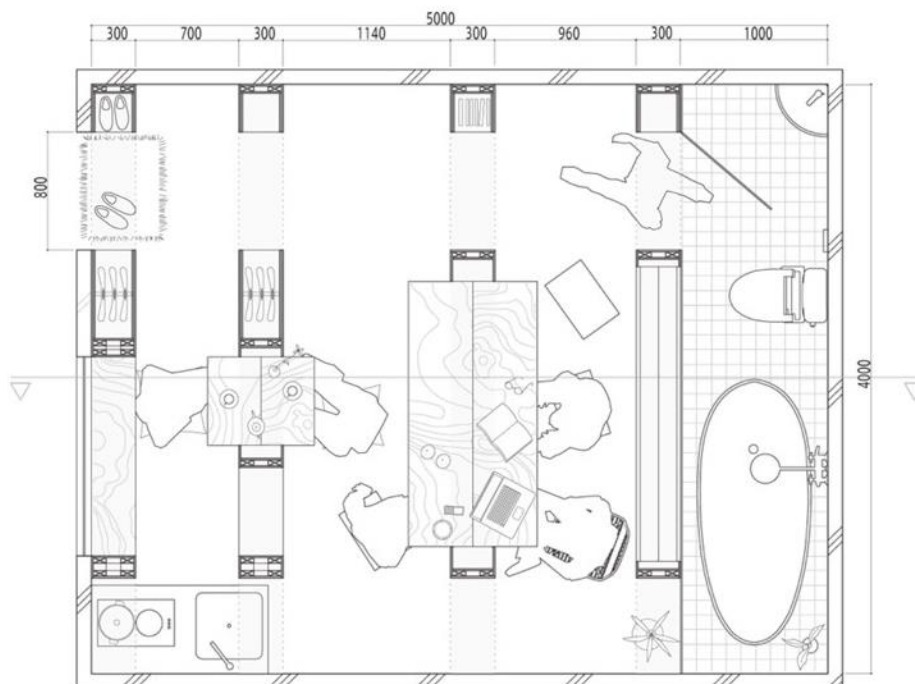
Distribución en planta de los espacios, 2014. Fuente: Plataforma Arquitectura.
